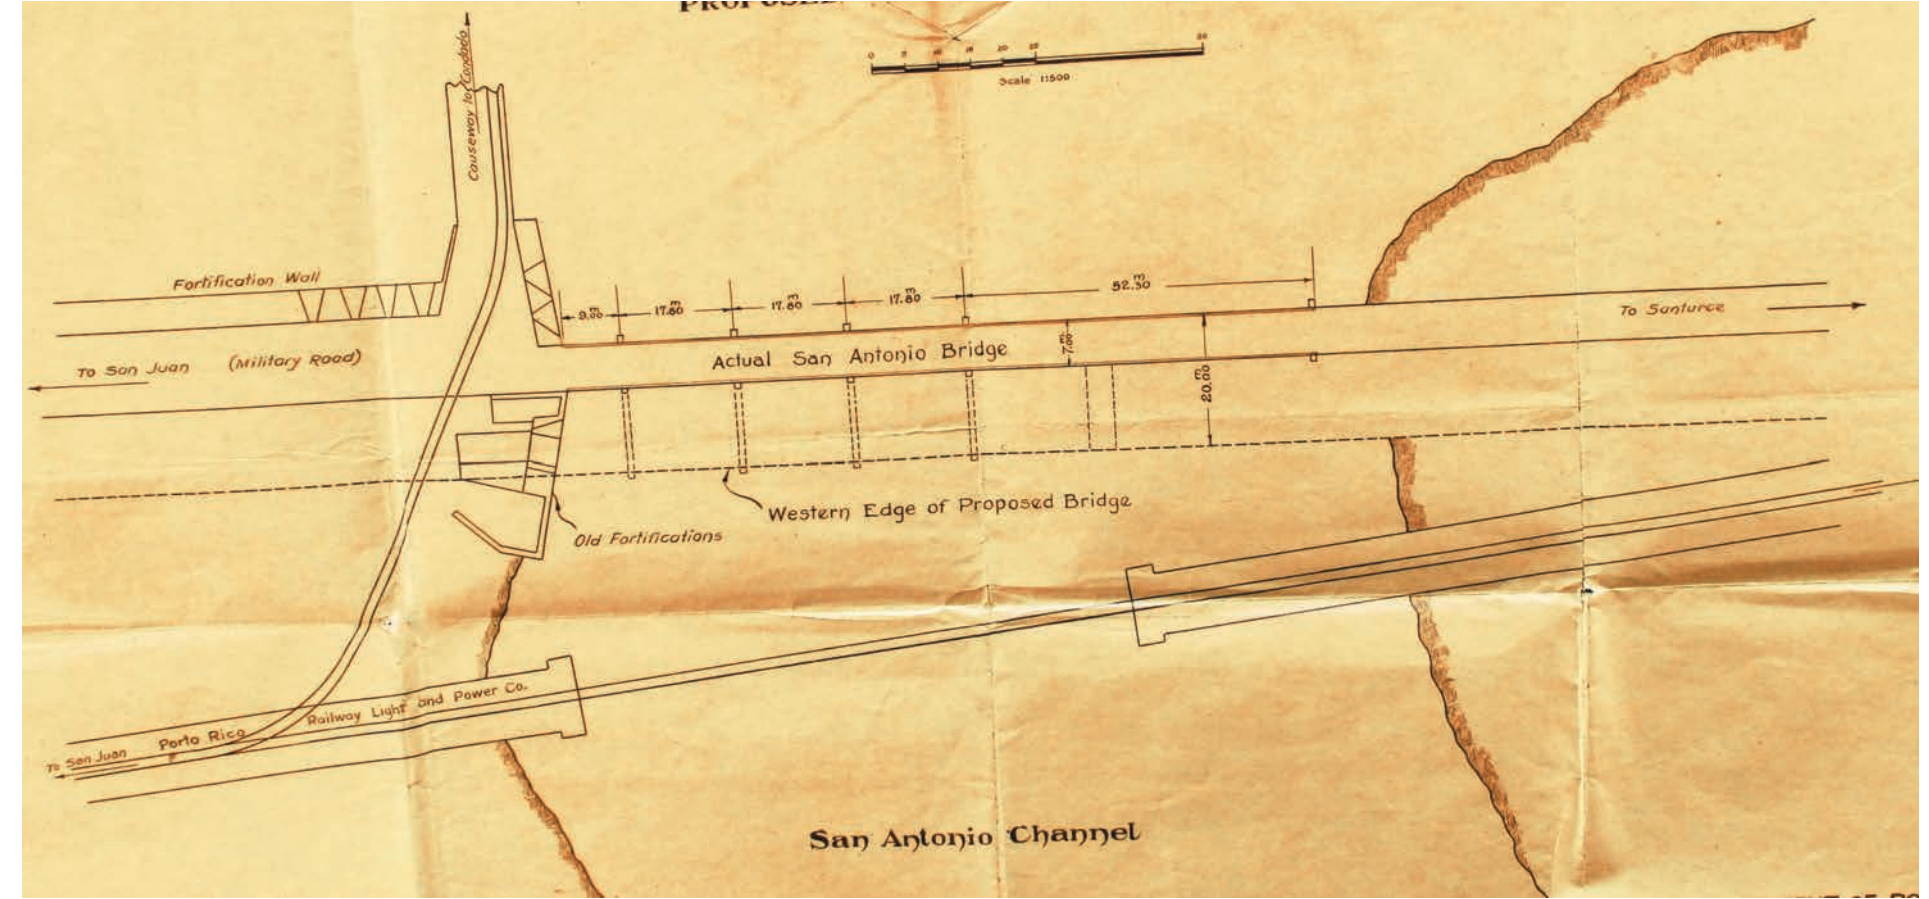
Segmento del plano de puente de San Antonio propuesto (color invertido) en 1923. Sketch showing location of Bridge over San Antonio Channel and proposed widening of actual road bridge, August 12, 1923. AGPR. Fondo de Obras Públicas, Serie Carreteras y Puentes, caja 2116.
